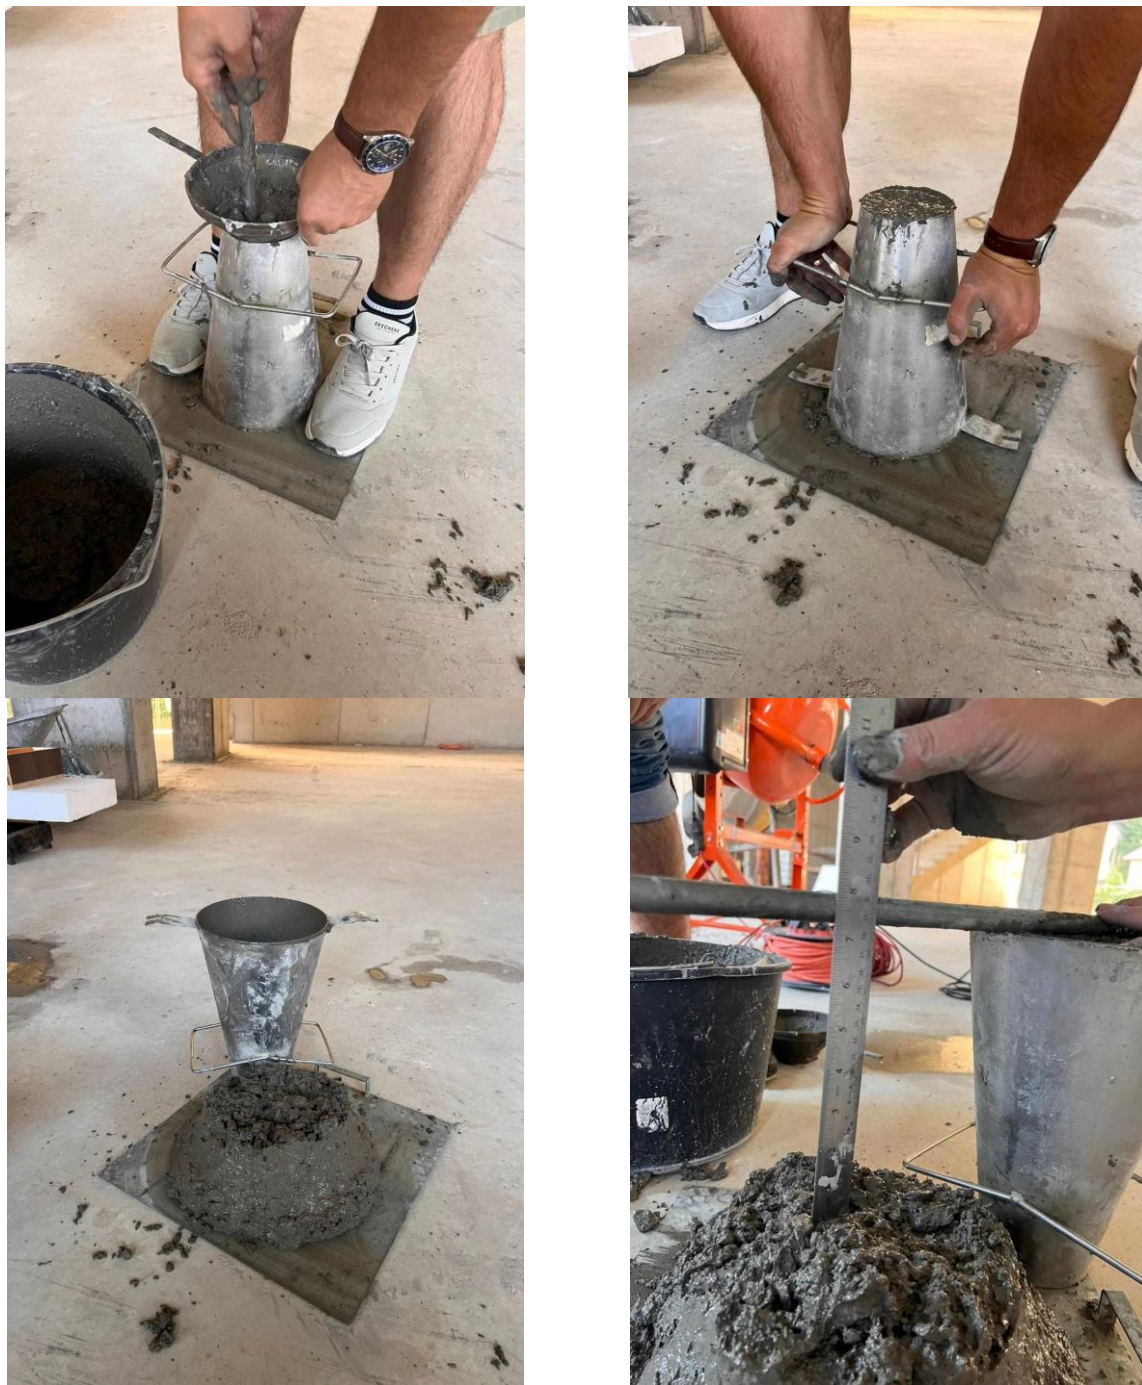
Matja e konsistencës së brumit të betonit ( Slum Test )
